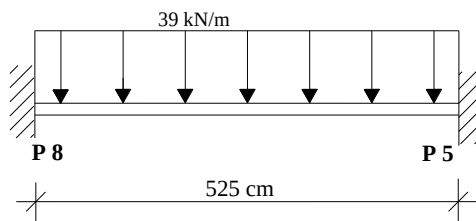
Esquema estático e carregamento no vão da viga adjacente ao pilar P5.
